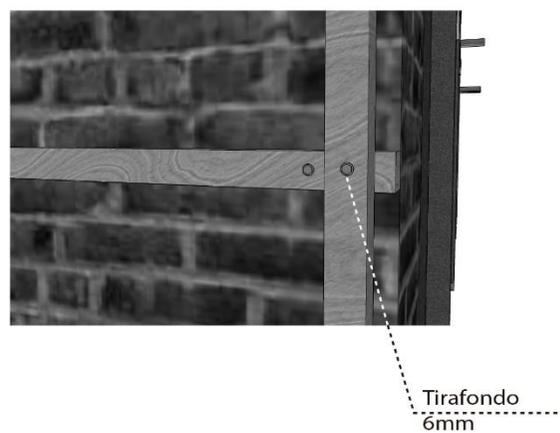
Detalle unión refuerzo horizontal y vertical
